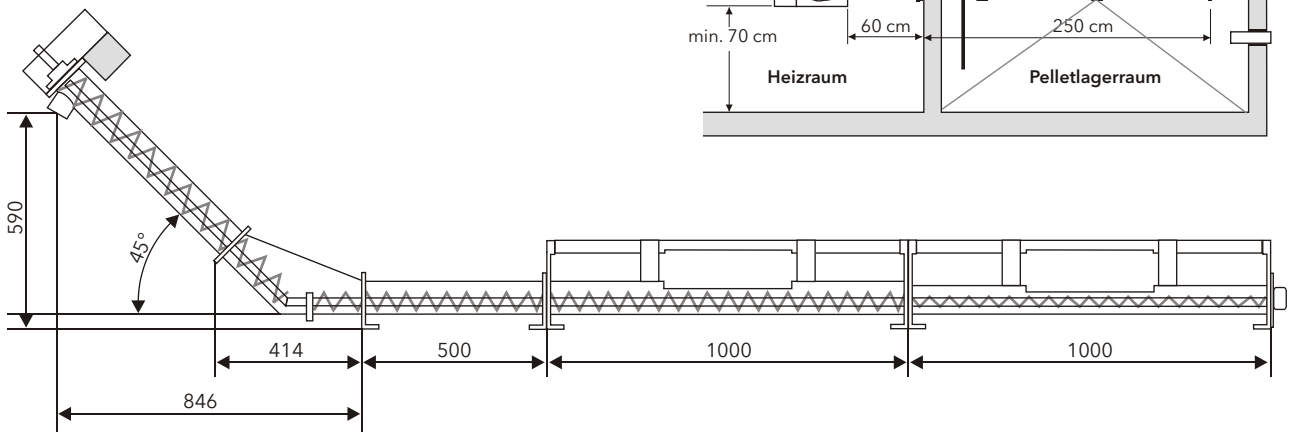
Knickschnecke in Maßen (mm) und Lage im Raum / Abb. zeigt Grundeinheit KA 1500 mit Verlängerung 1.000 mm
